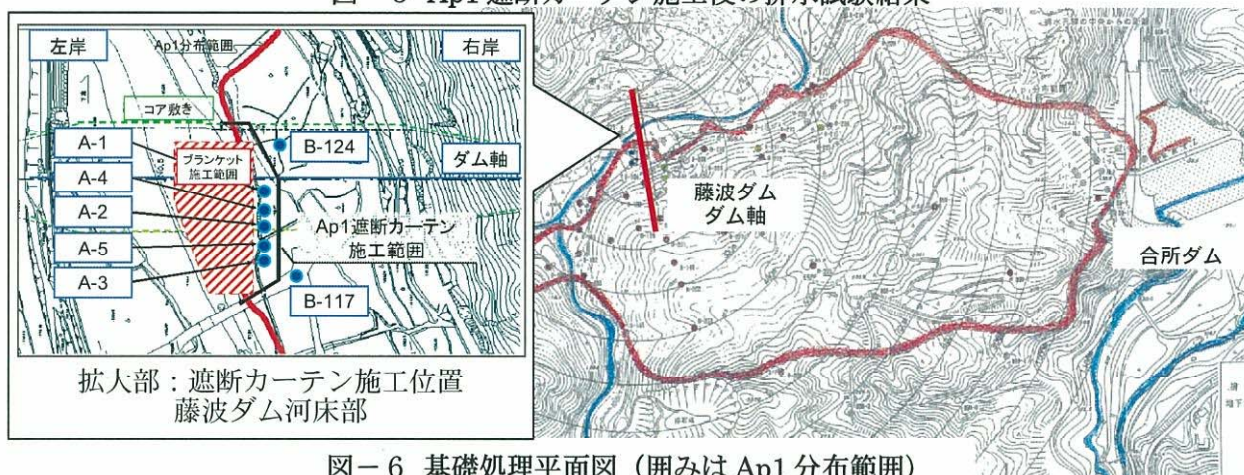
基礎処理平面図 (囲みは Ap1 分布範囲)
